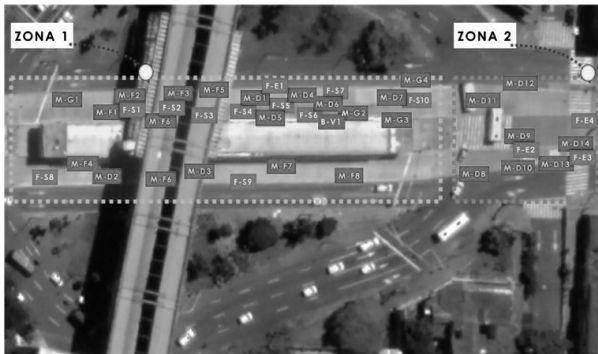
Levantamiento planimétrico de daños Zona 1 y Zona 2.
